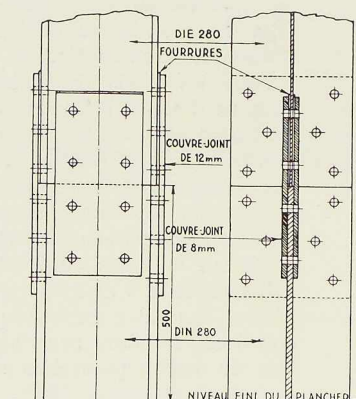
Assemblage type d'une poutrelle Grey D.I.N. avec une poutrelle D.I.E. Les épaisseurs moindres de l'âme et des ailes sont rattachées par des fourrures.
